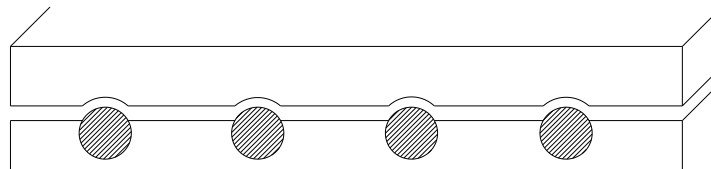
Delaminazione del calcestruzzo in seguito alla fessurazione indotta dalla corrosione
